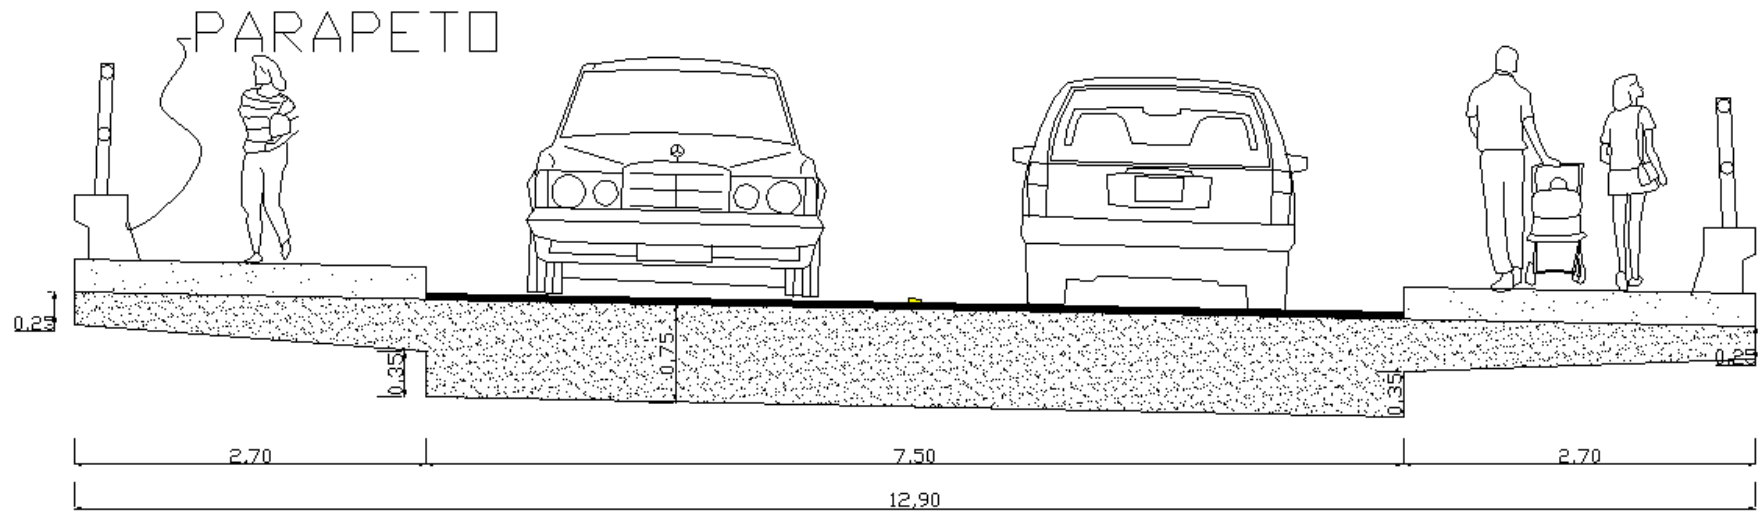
Sección transversal del puente vehicular del “El Playón”.
